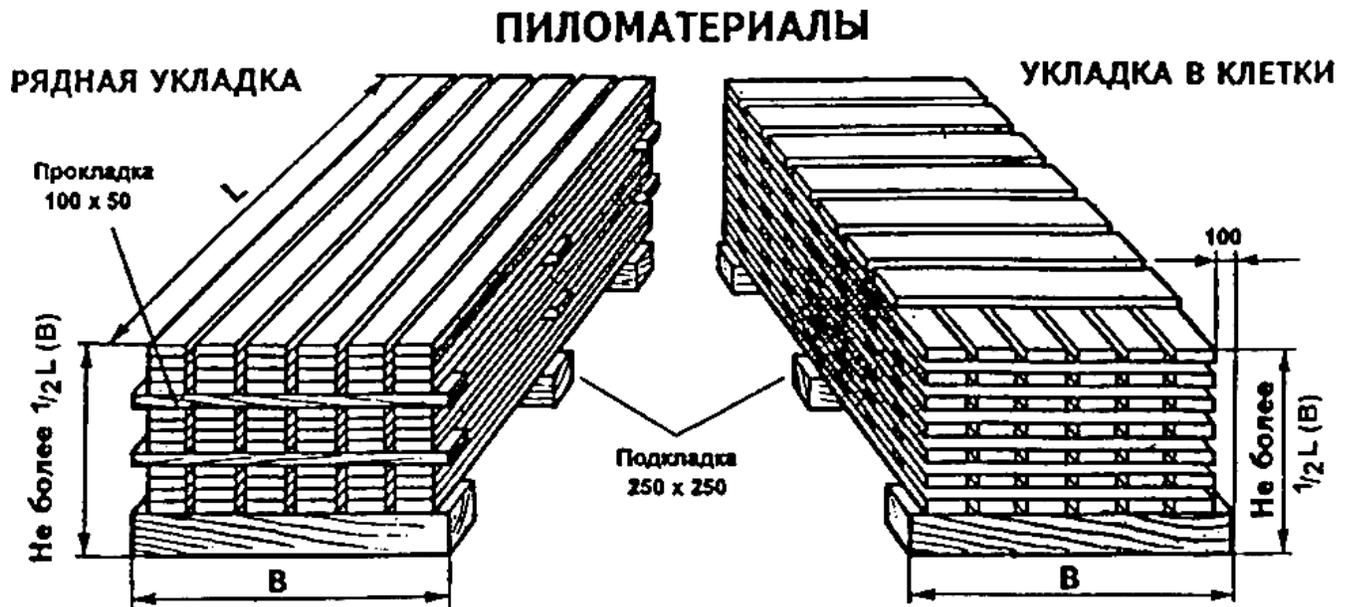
Рядная укладка и укладка в клетки пиломатериалов
